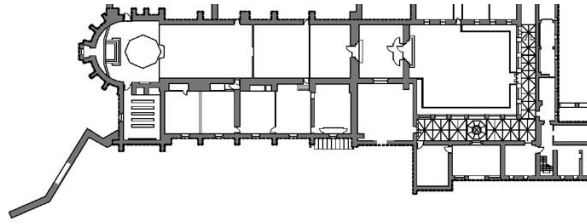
Planta de la iglesia de Santa María de Miraflores.
